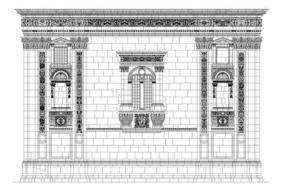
Levantamiento de planimetría Fachada Este. Informe sobre la intervención en el primer cuerpo de la torre de la catedral de Murcia realizado para la documentación de patologías detectadas y tratamientos aplicados. 2010. Artelan Restauración S.L.
